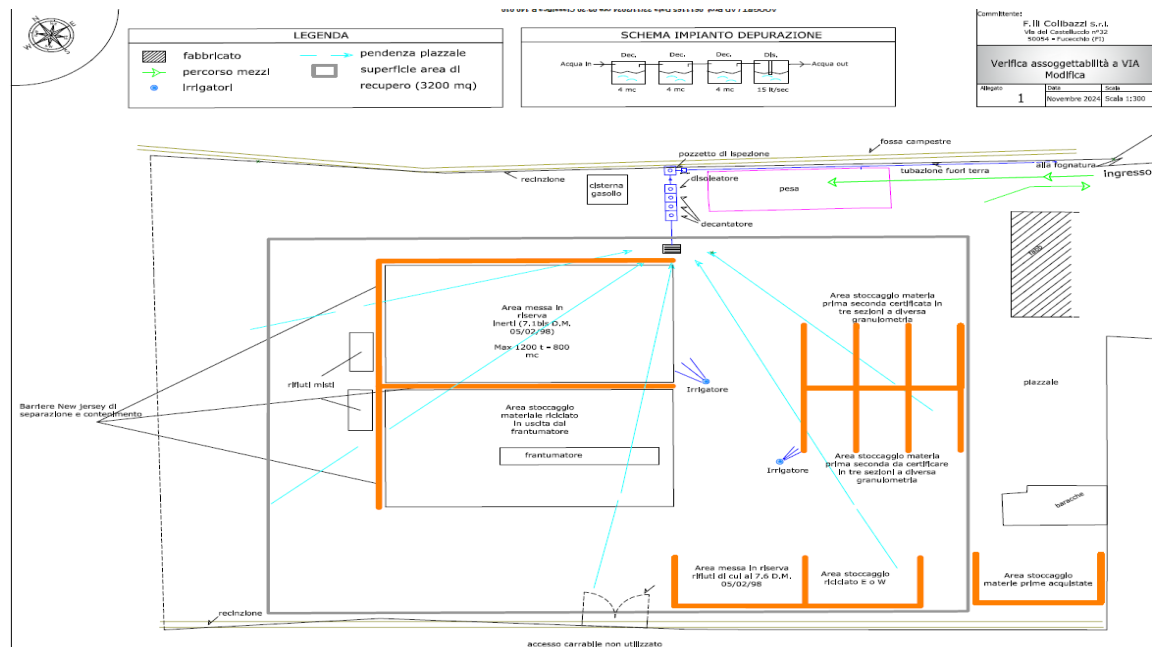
Planimetria del sito: in grigio, area adibita ad attività di recupero
